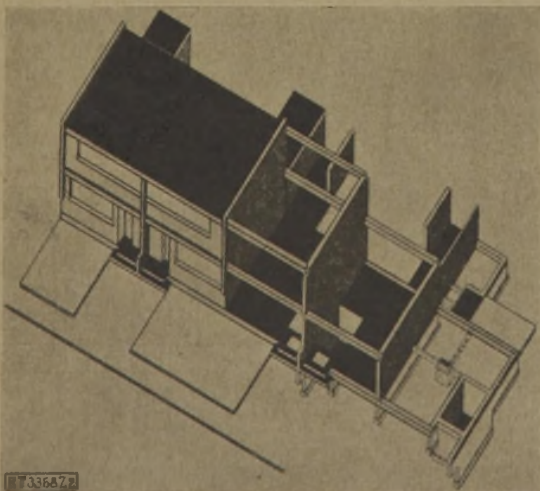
Konstruktionsschema der Siedlung Dessau-Törten. Architekt Walter Gropius. Baukasten im Großen; tragende Trennungswände aus Betonschlackenhohlsteinen, Querverbindungs- und Deckenbalken aus armiertem Beton. Montage mittels Leichtkran.
